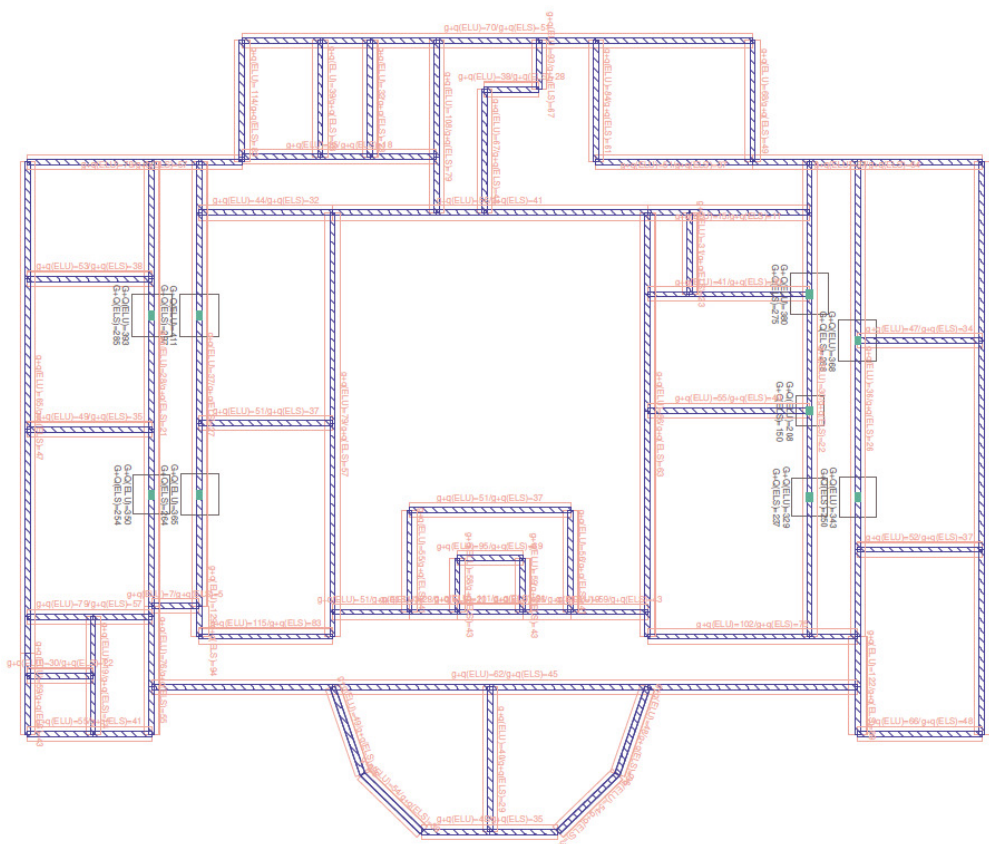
Plan des fondations / descente de charge – Fondation superficielle
